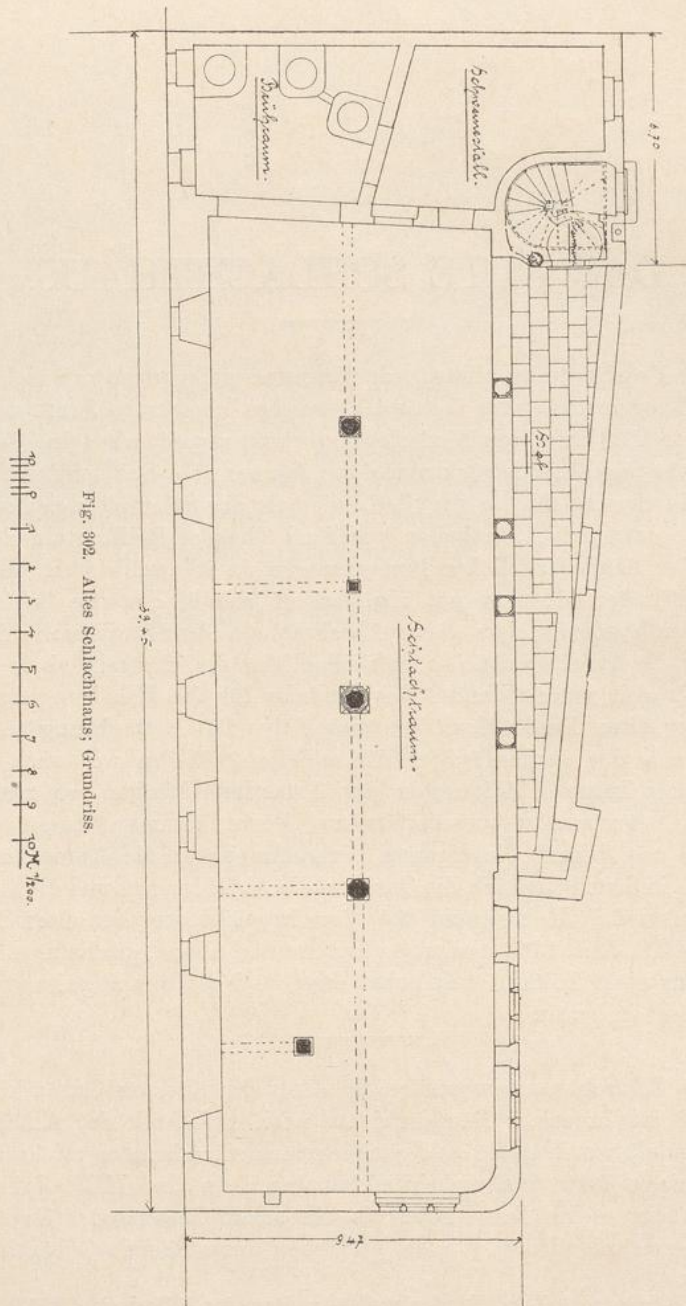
Altes Schlachthaus; Grundriss.
